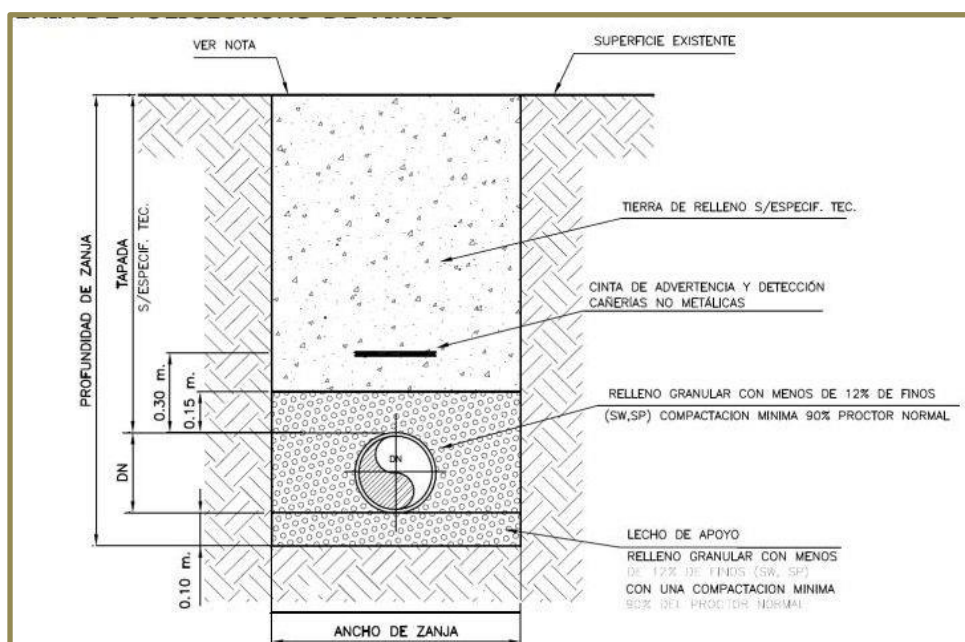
Vista de corte del plano de instalación de caño de PVC.
